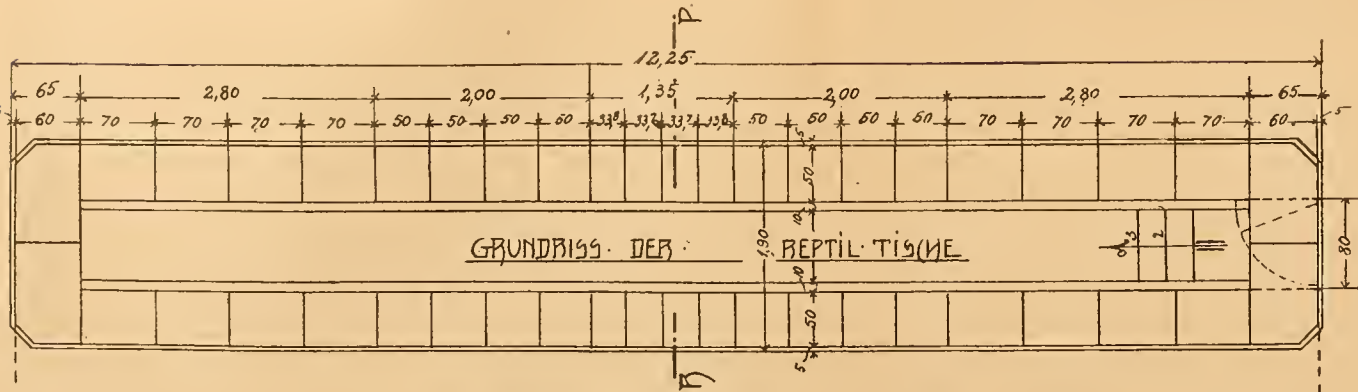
Fig. III. Grundriss der Tische für Reptilien und Amphibien.
